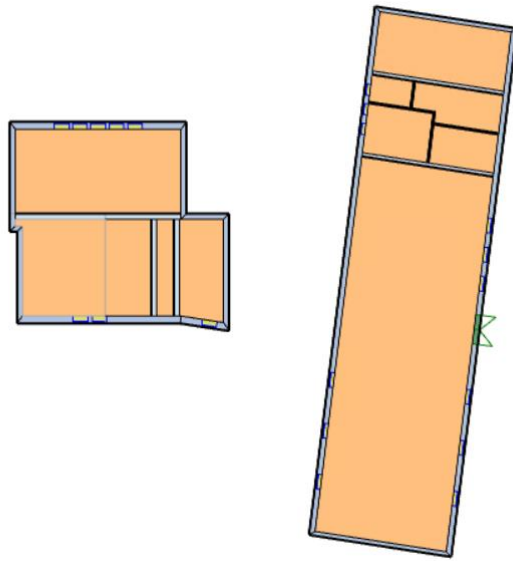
Grundriss Kellergeschoss, zoniert
